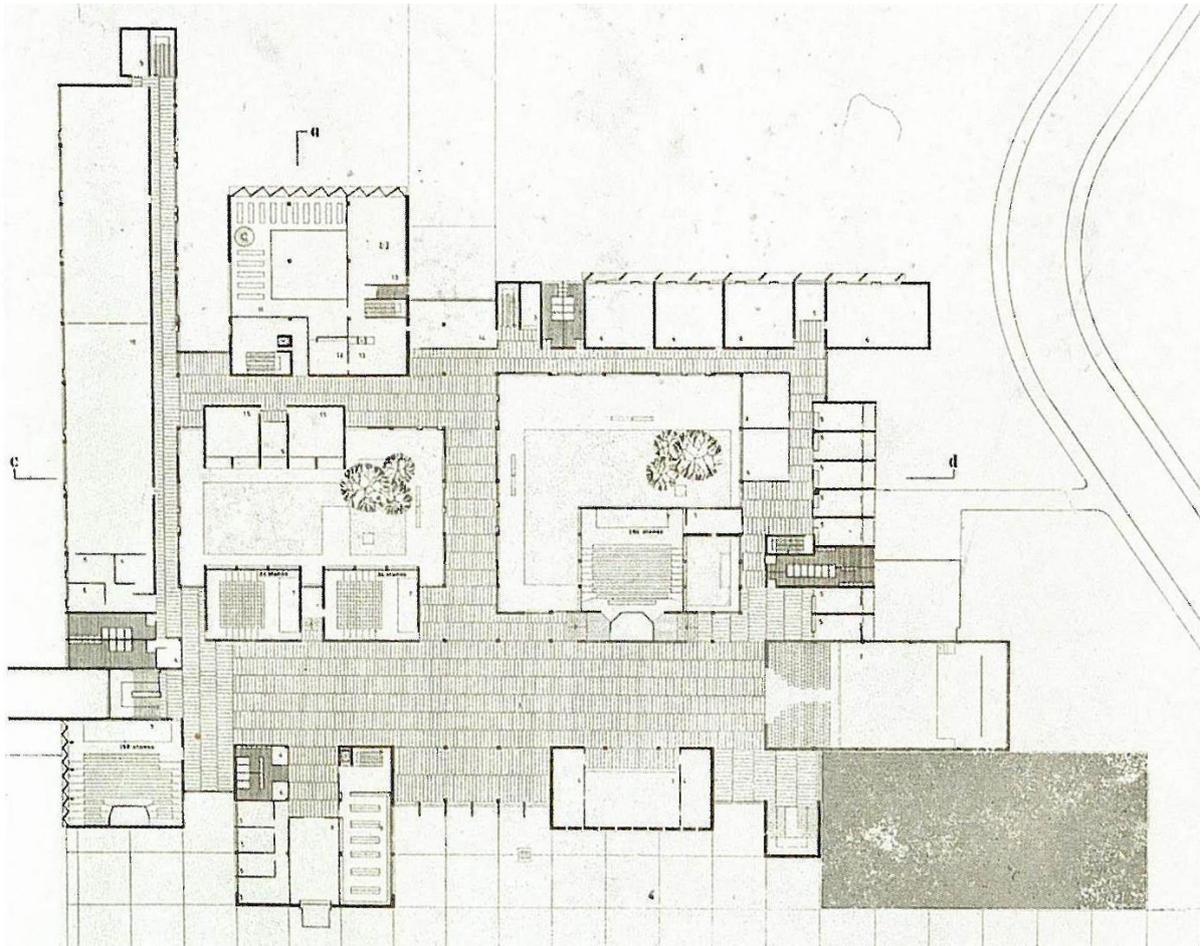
Planta do 1º piso da FEP, Porto, 1961
